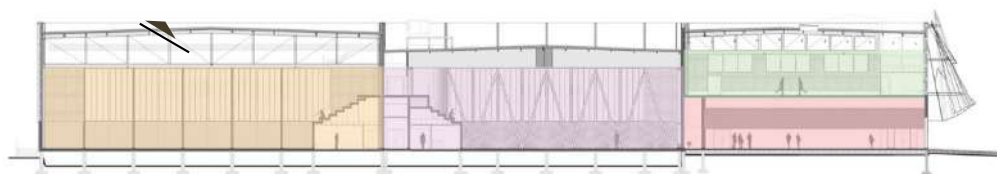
Corte transversal do complexo esportivo / Fonte: editado pela autora
